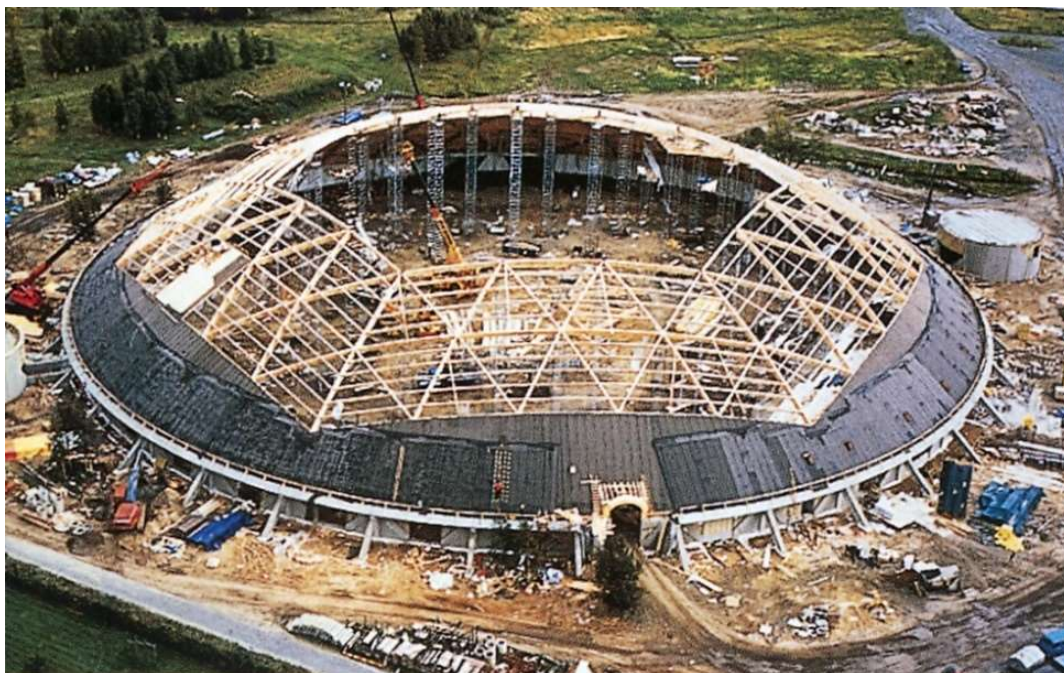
Střešní konstrukce Stephanovy soustavy [1]
